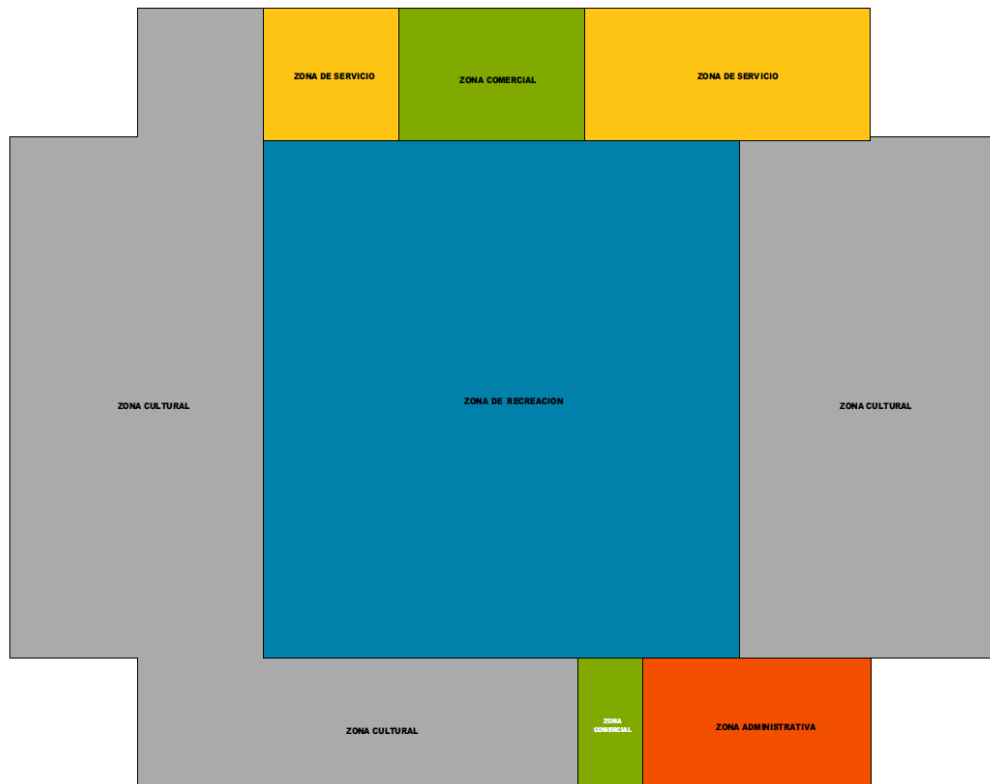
Zonificación planta baja (fuente: elaboración propia)
